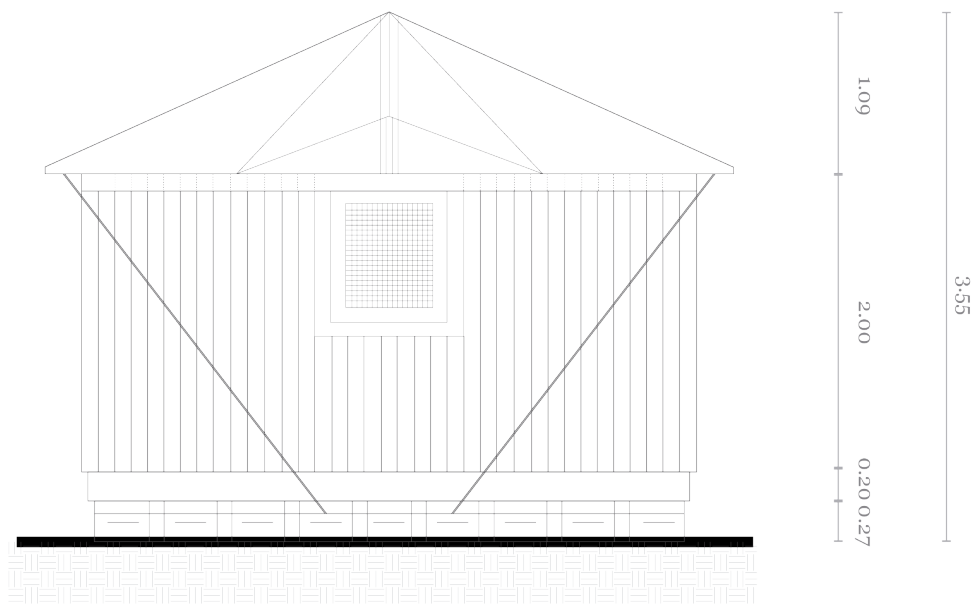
Elevación Lateral Paper Log House. Elaboración: Autores. Escala 1:50
